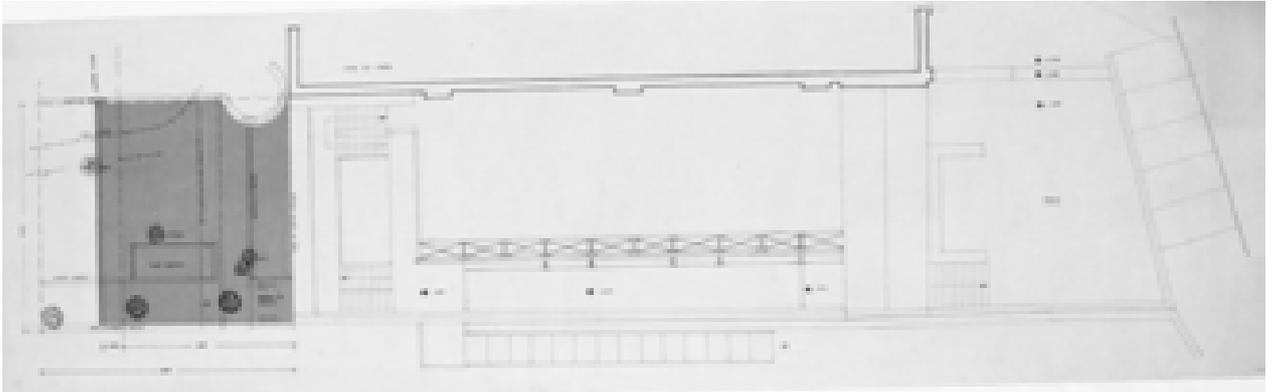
Studio pianta delle coperture – stato futuro - s.d. (AABS-95.302)
